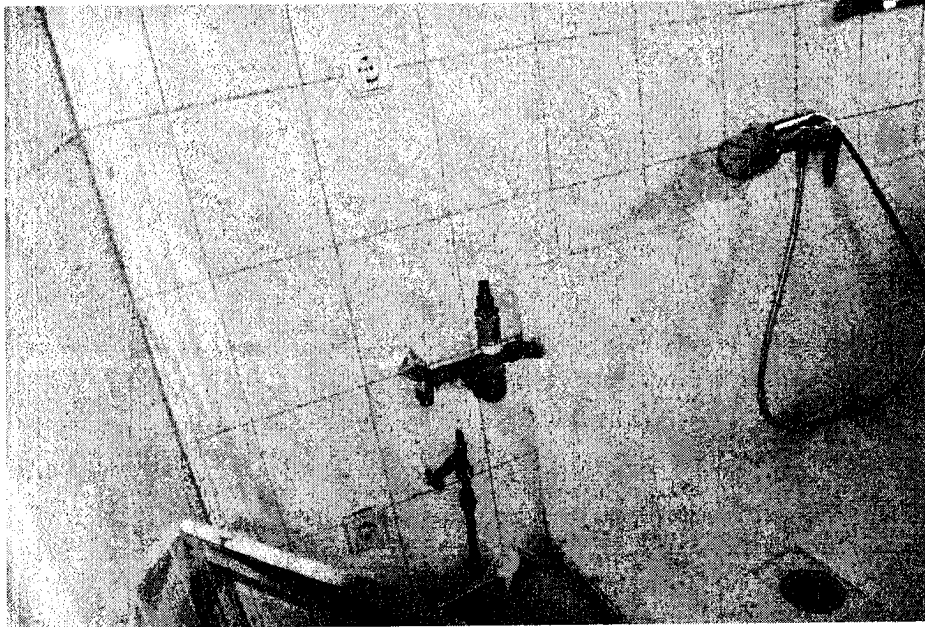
Erdgeschoss Duschbad, mit Waschmaschinenanschluss, die Funktionsfähigkeit wird unterstellt
